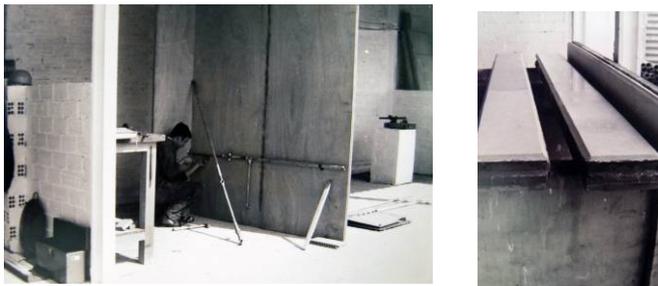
Taller de fontanería y piezas de fachada de fibrocemento.
